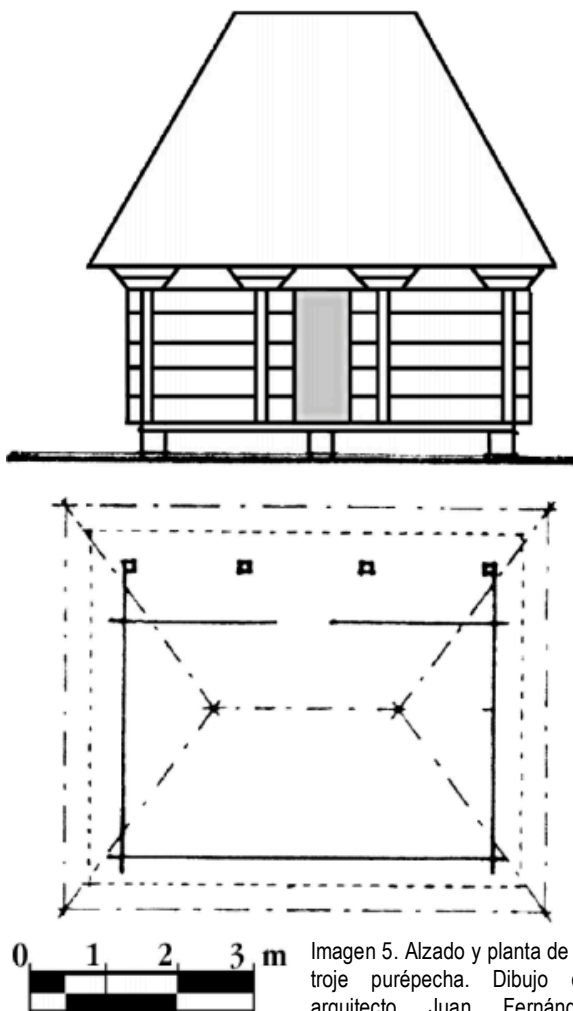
Alzado y planta de un troje purépecha. Dibujo del arquitecto Juan Fernández Bontempo (García, 2012)
